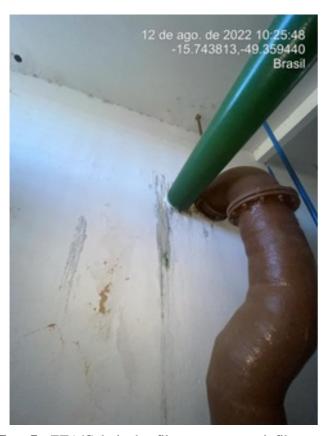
ETA/Galeria dos filtros com novas infiltrações e eflorescências.
